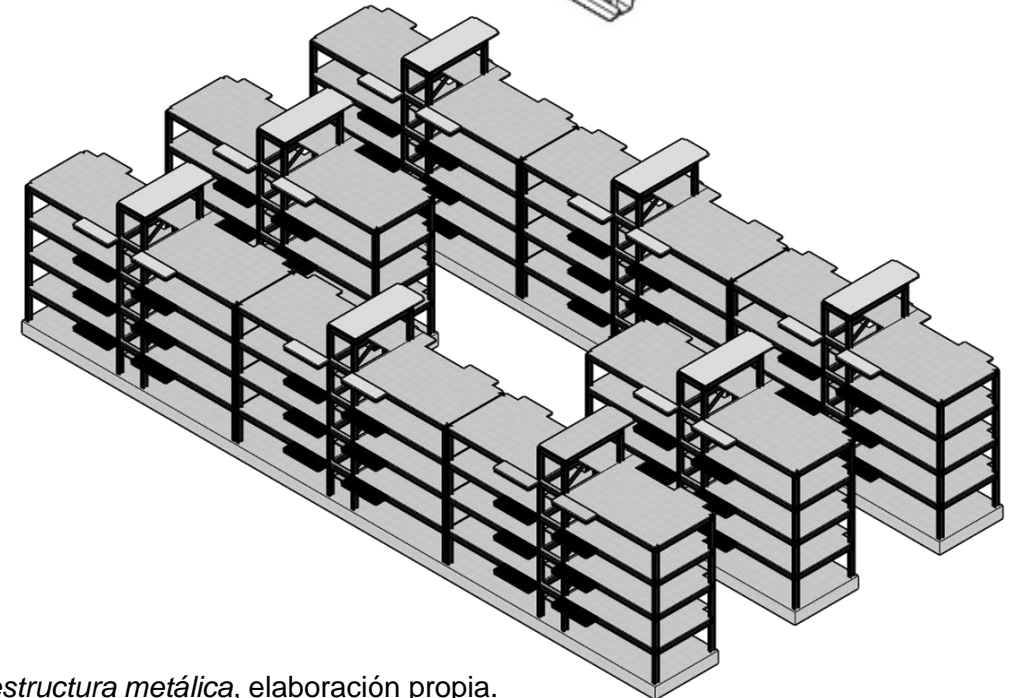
Esquemas de estructura metálica, elaboración propia.
